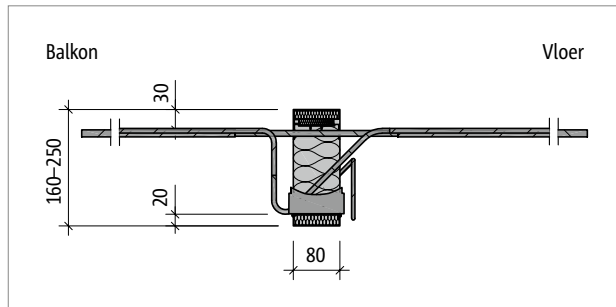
Schöck Isokorf® T type K-E-M4: Bovenaanzicht
